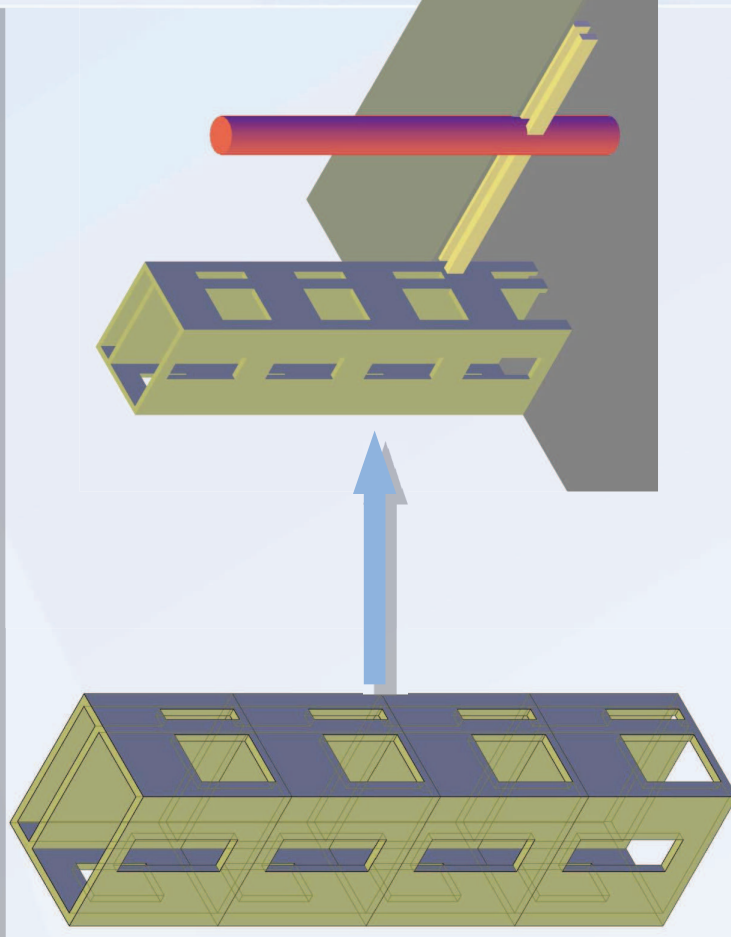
Sistema de tubos de concreto colado en sitio rigidiendo marcos porticados. Sin Escala.
